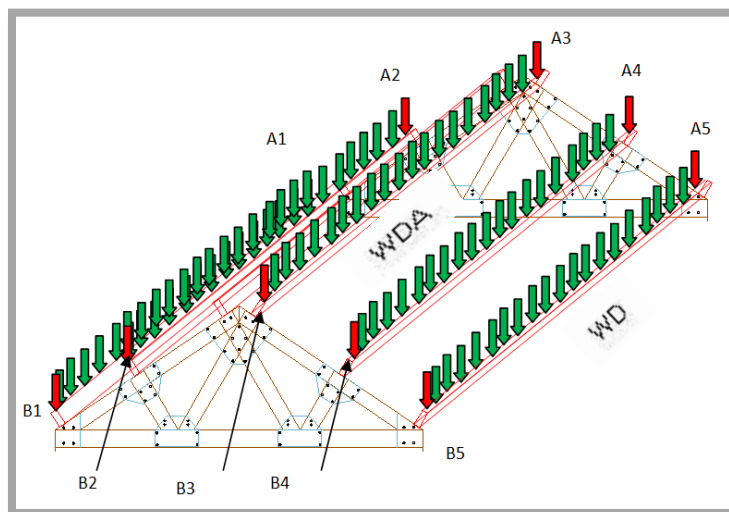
Distribución de las cargas WDA y WD, en las viguetas, en el tramo A-B.
